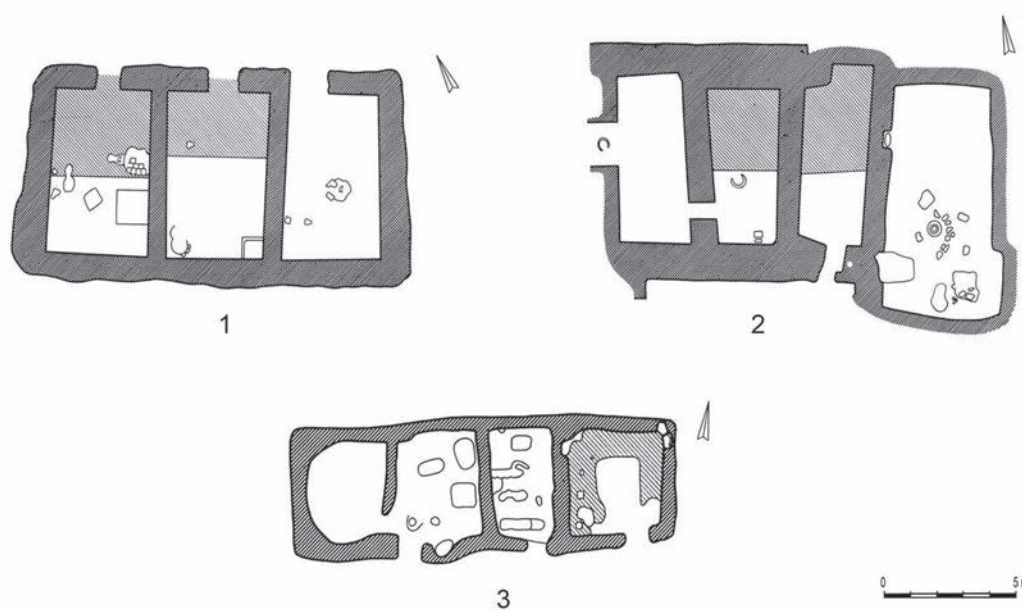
Усадебные дома Хорезма линейной планировки: 1 – дом 1 близ Бутен-тау;
